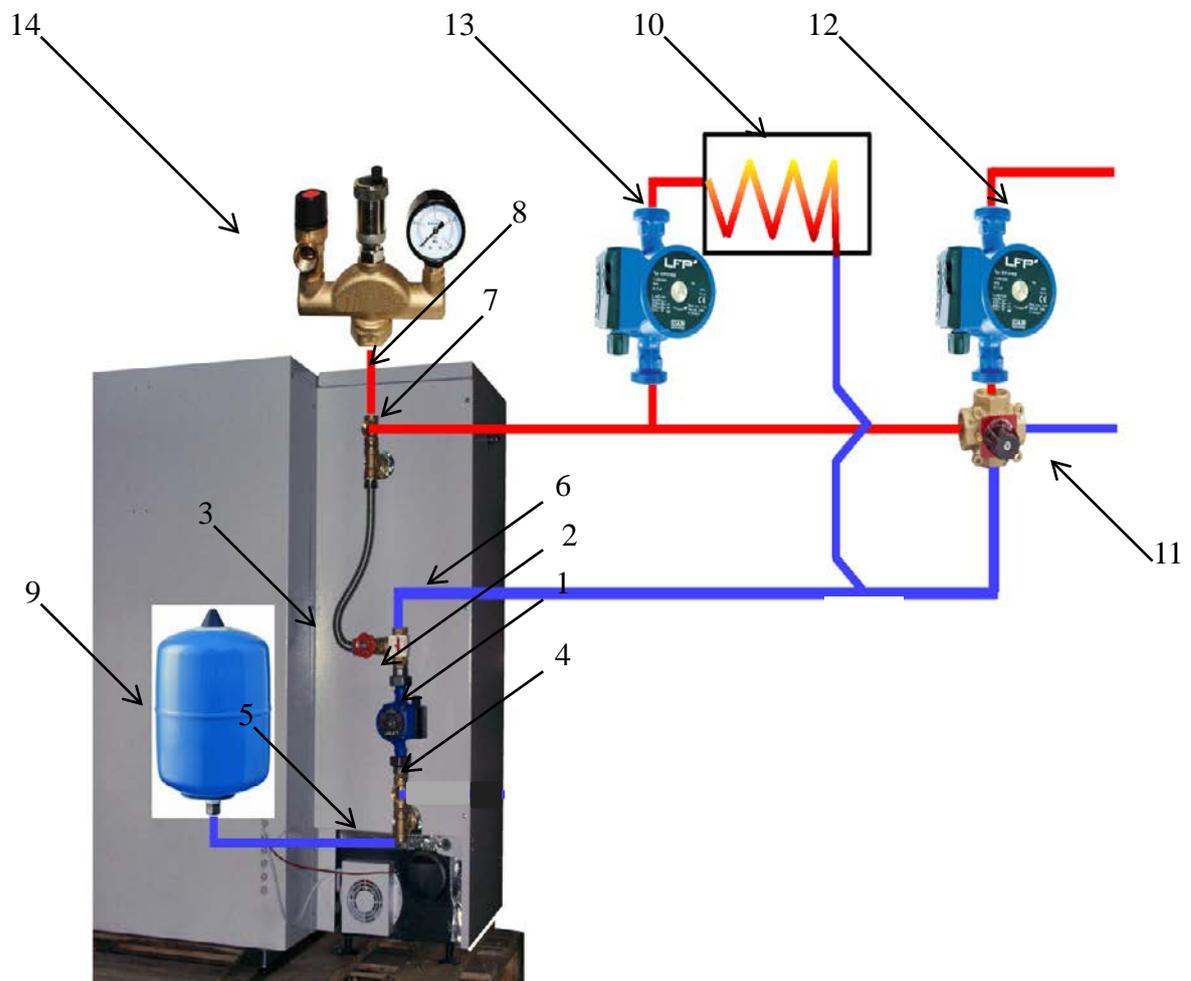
Beschreibung des hydraulischen Kit mit Thermostatventil , Installation im geschlossenen System mit Ausdehnungsgefäß:
